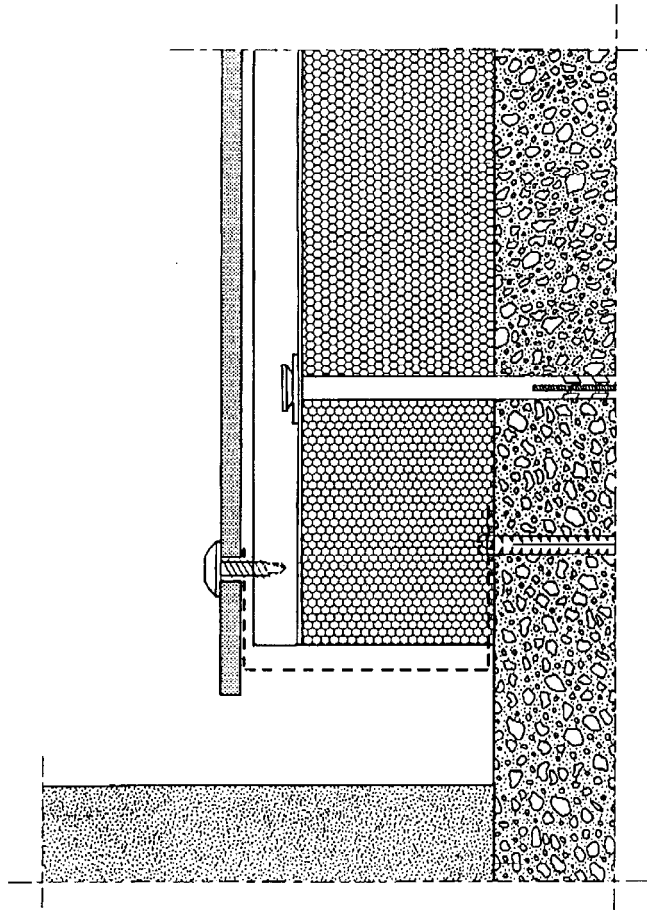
Départ d'ouvrage – Coupe verticale - Vêtage
